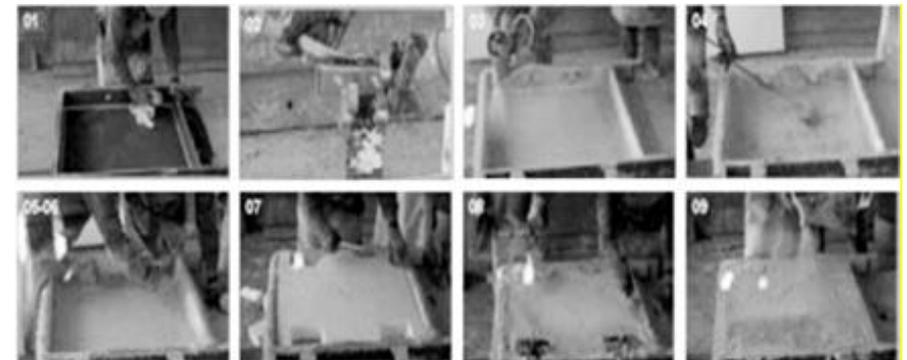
Proceso de fabricación de un Panel de Hormigón Prefabricado
